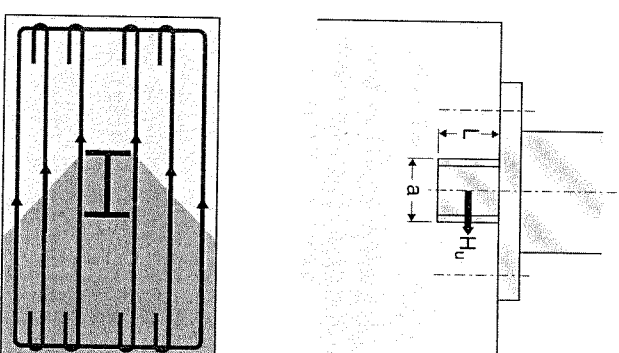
Transfert de l'effort tranchant par bêche et disposition des armatures.
